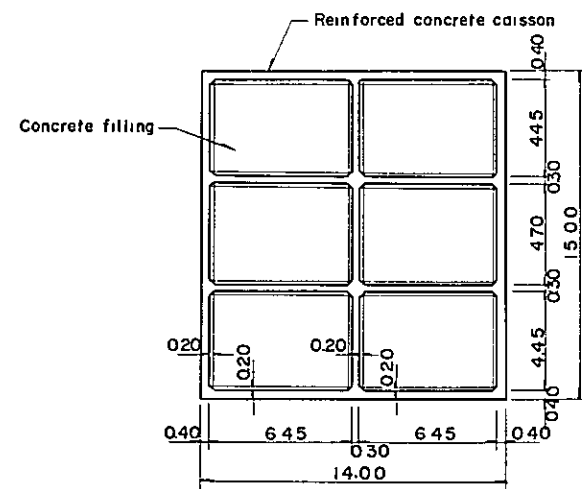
ケーソン式 (コンクリート中詰) 防波堤 (1)
